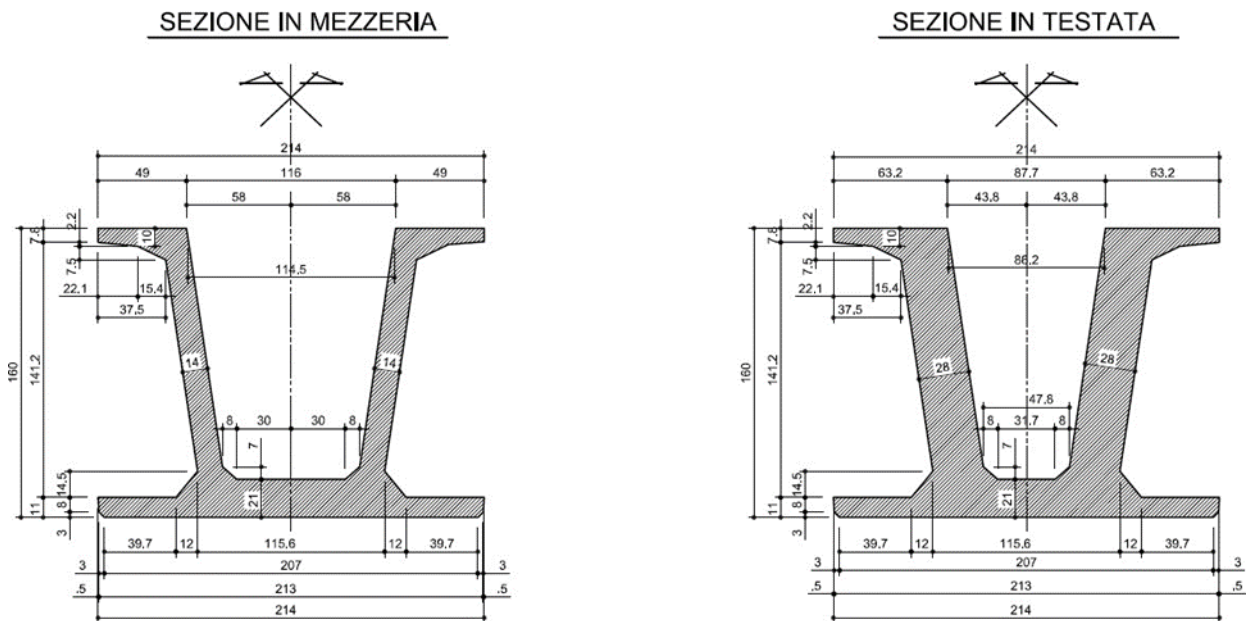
Sezione trasversale trave “tipo CIR” 214/160/14-28cm
